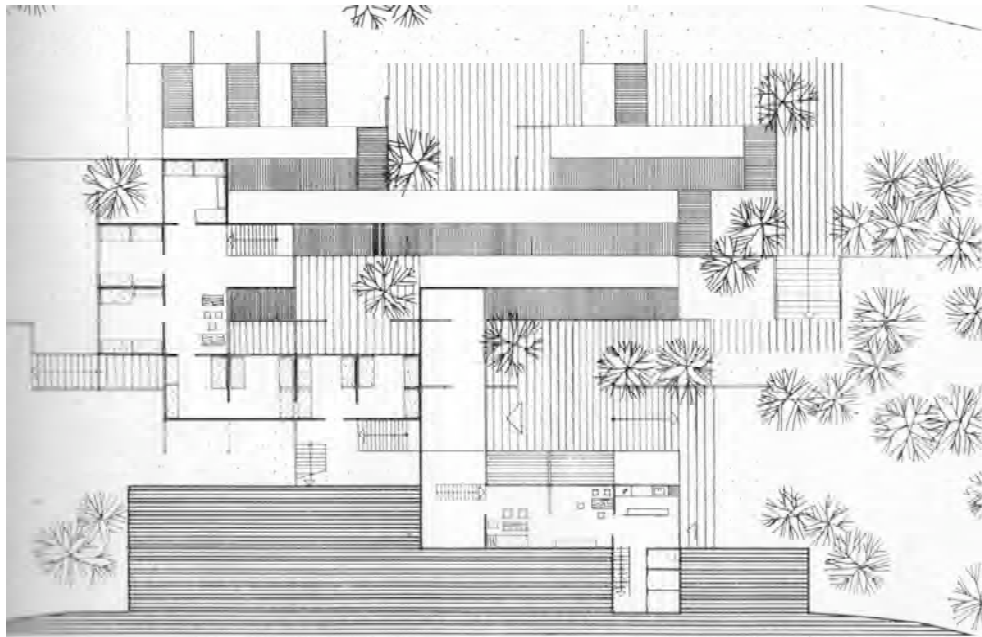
Grundriss des Jugendheim-Entwurfes (Bauwelt 52.1961)
